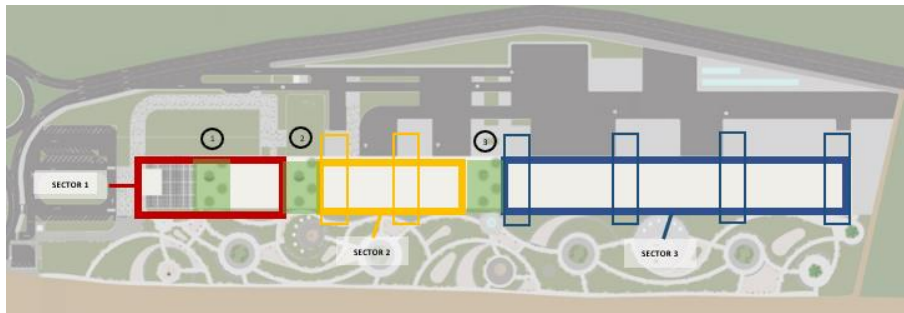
Vista de planta de sectores en el proyecto. FUENTE: Elaboración Propia
